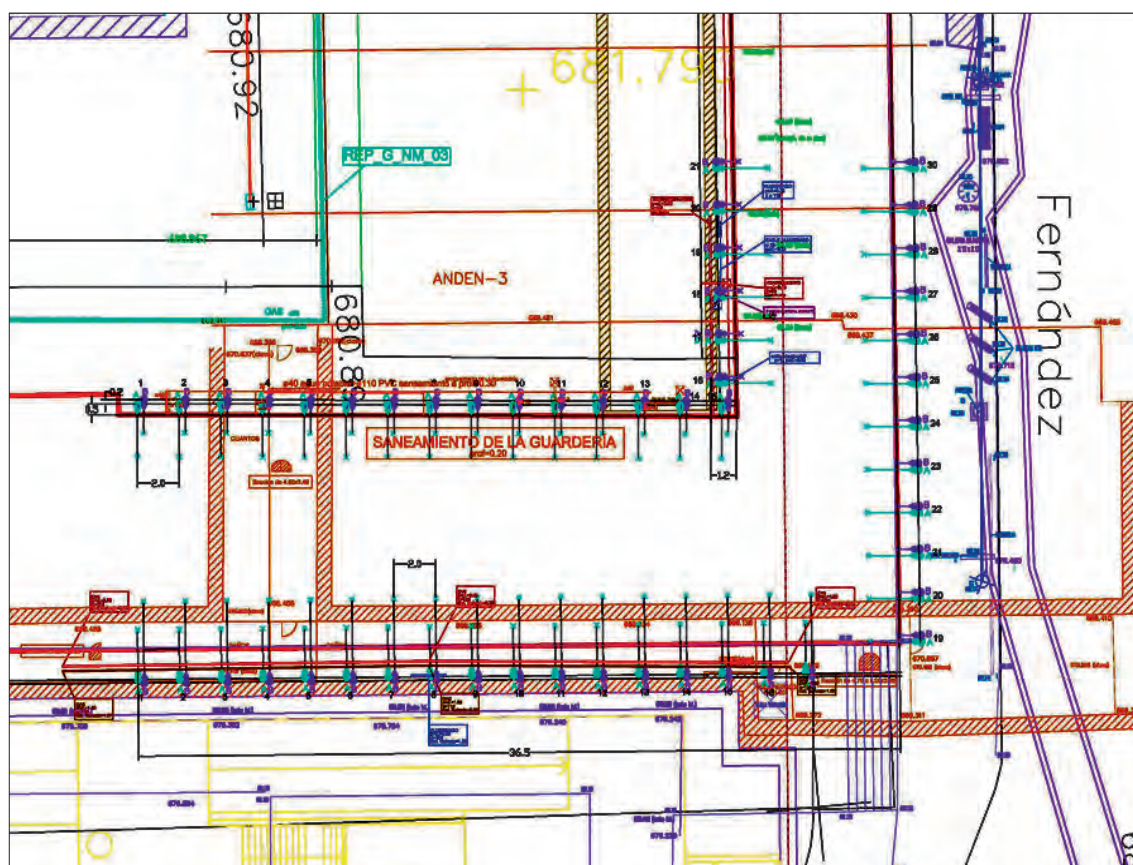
PLANTA DE LA GUARDERÍA CON TALADROS DE INYECCIÓN.
